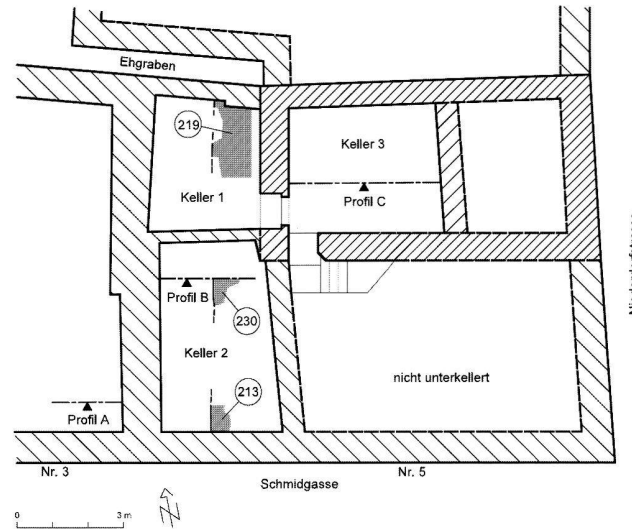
Zürich, Schmidgasse 5. Hausgrundriss mit den Grabungsflächen in den Kellern 1–3 und der Lage der Profile A–C (Profil A in Schmidgasse 3). Dunkel schraffiert der Grundriss des Kernbaus; im Westteil eine ältere Steinsetzung (Pos. 213, 219, 230). Illustration Stadtarchäologie Zürich.
